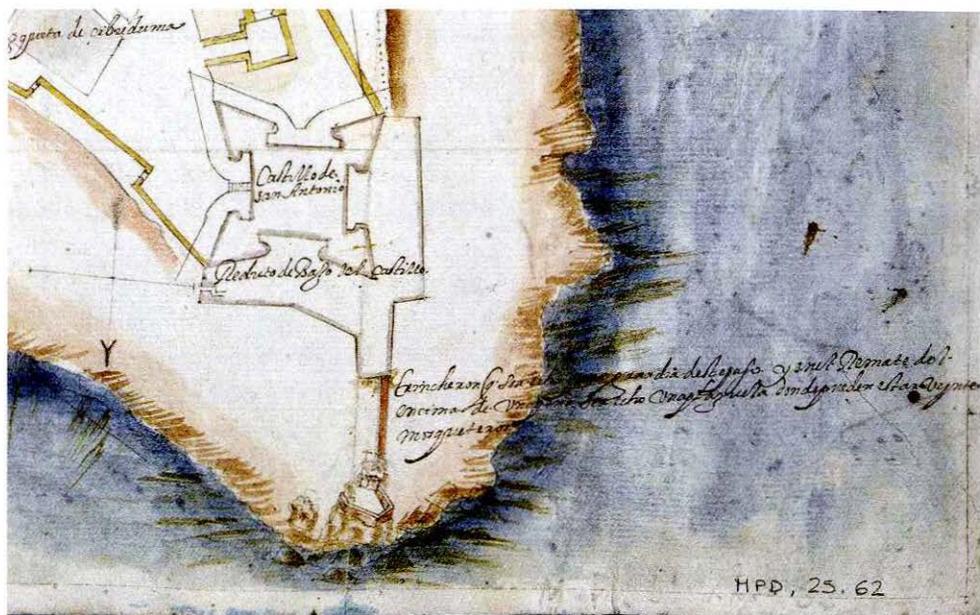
Bautista Antonelli. Planta de Larache de 15 de marzo de 1612 (detalle). Archivo General de Simancas, MPD, 25, 62.
